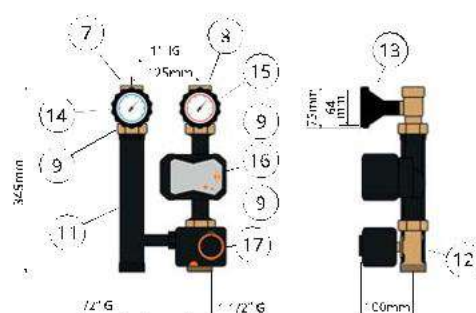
Pumpengruppe HZ G DN 25 gemischter Heizkreis
